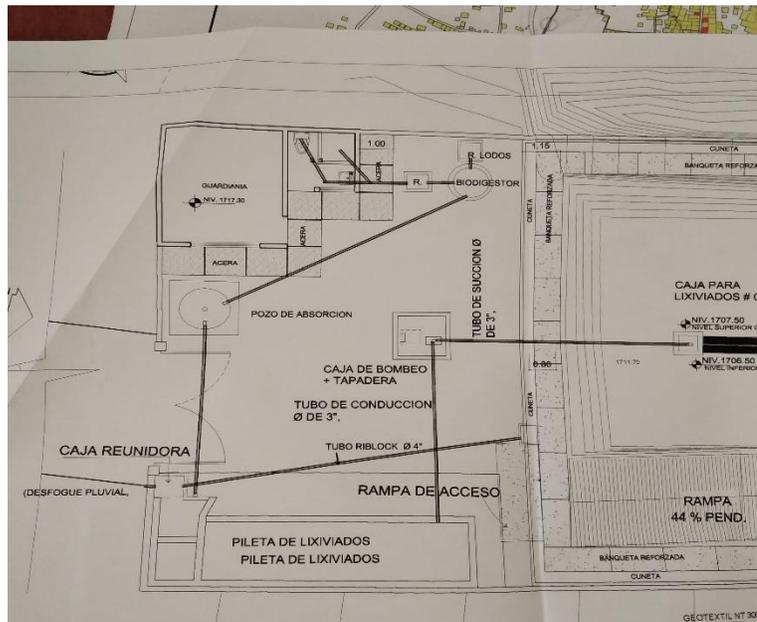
A. Plano, Planta de drenaje de lixiviados, relleno sanitario municipal.
